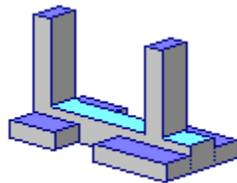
Trabe de Cimentación o Zapata con Viga de Amarre
